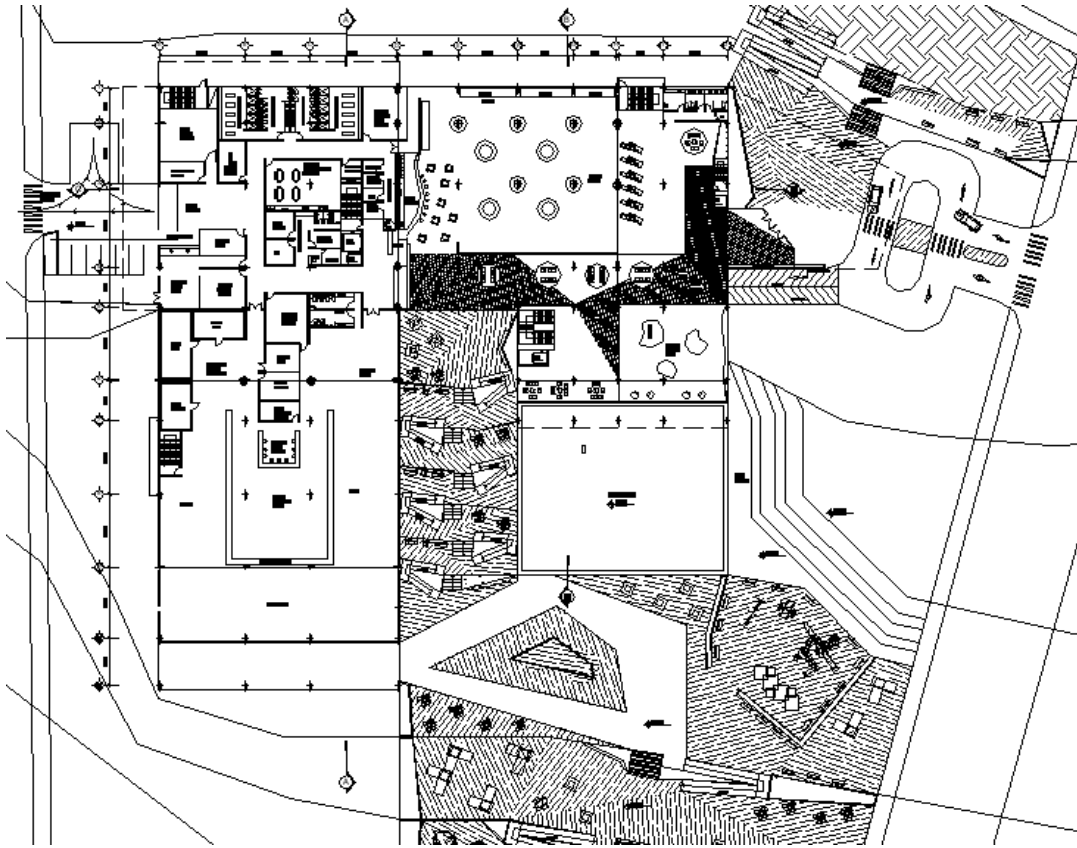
Planta Baja nivel +/-0.00m. (2017).
